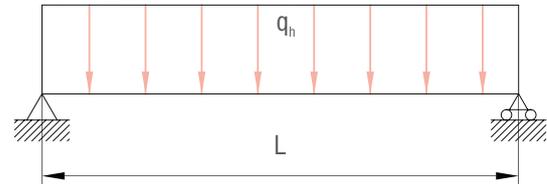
схема нагружения эксплуатационной нагрузкой
